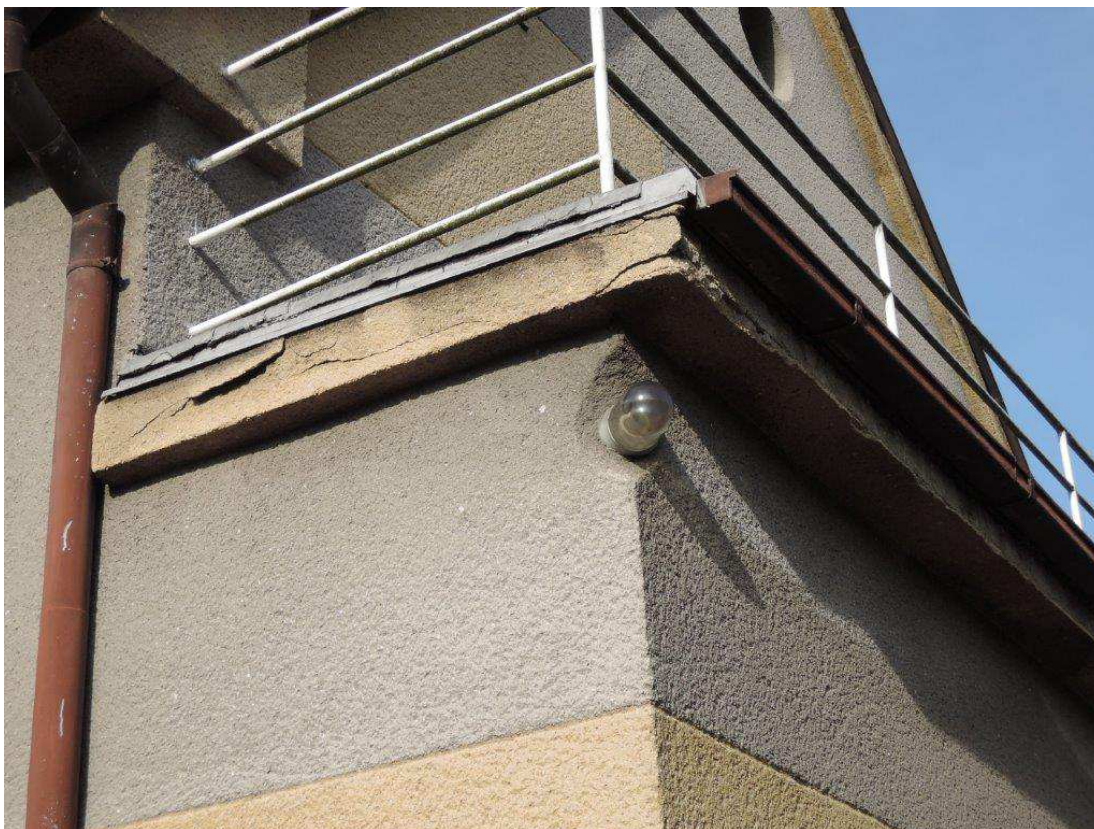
Pohled na jihovýchodní část fasády – praskliny v římse
